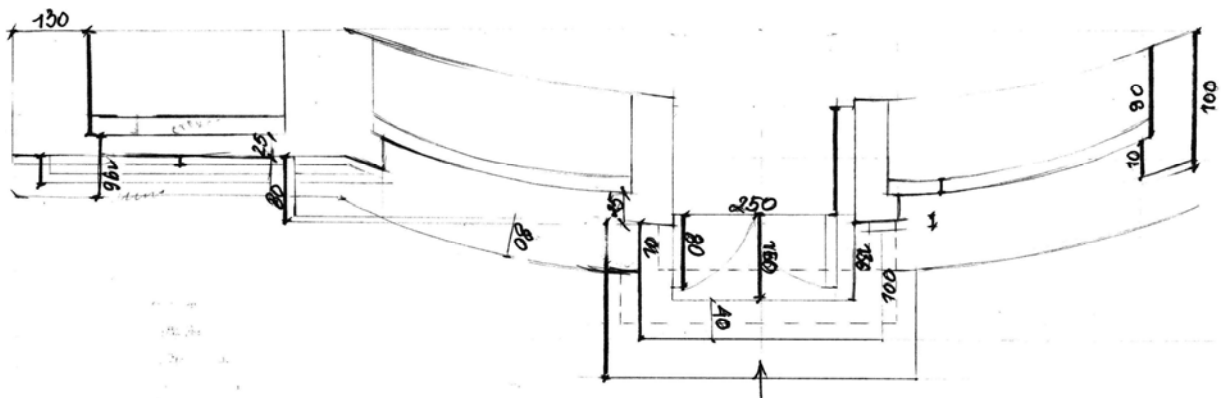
Фрагмент плану з входом у громадську будівлю
